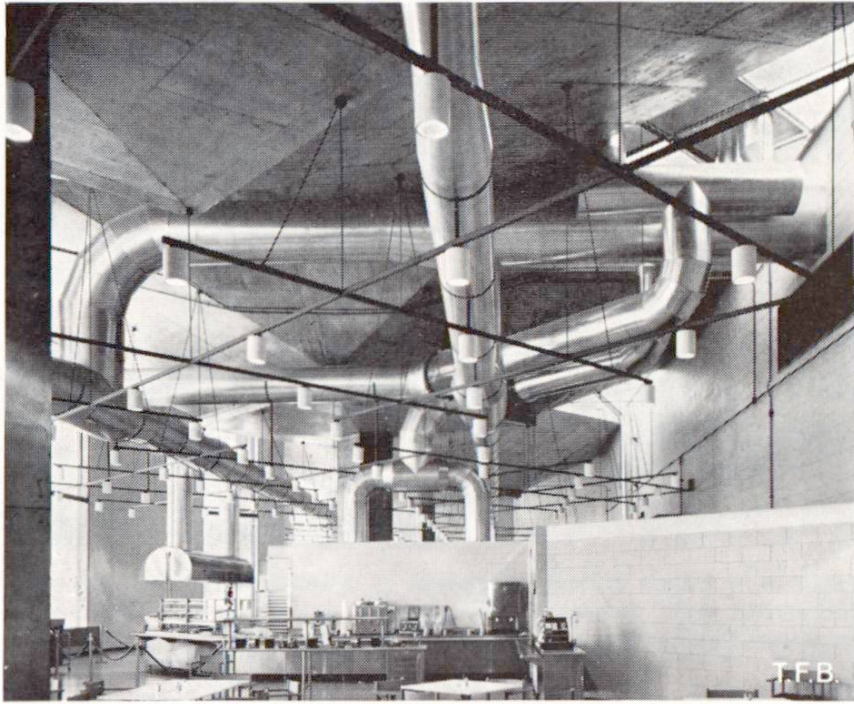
Dans la cantine, les énormes canaux de ventilation au revêtement chromé forment une sorte de plafond sculpté.
